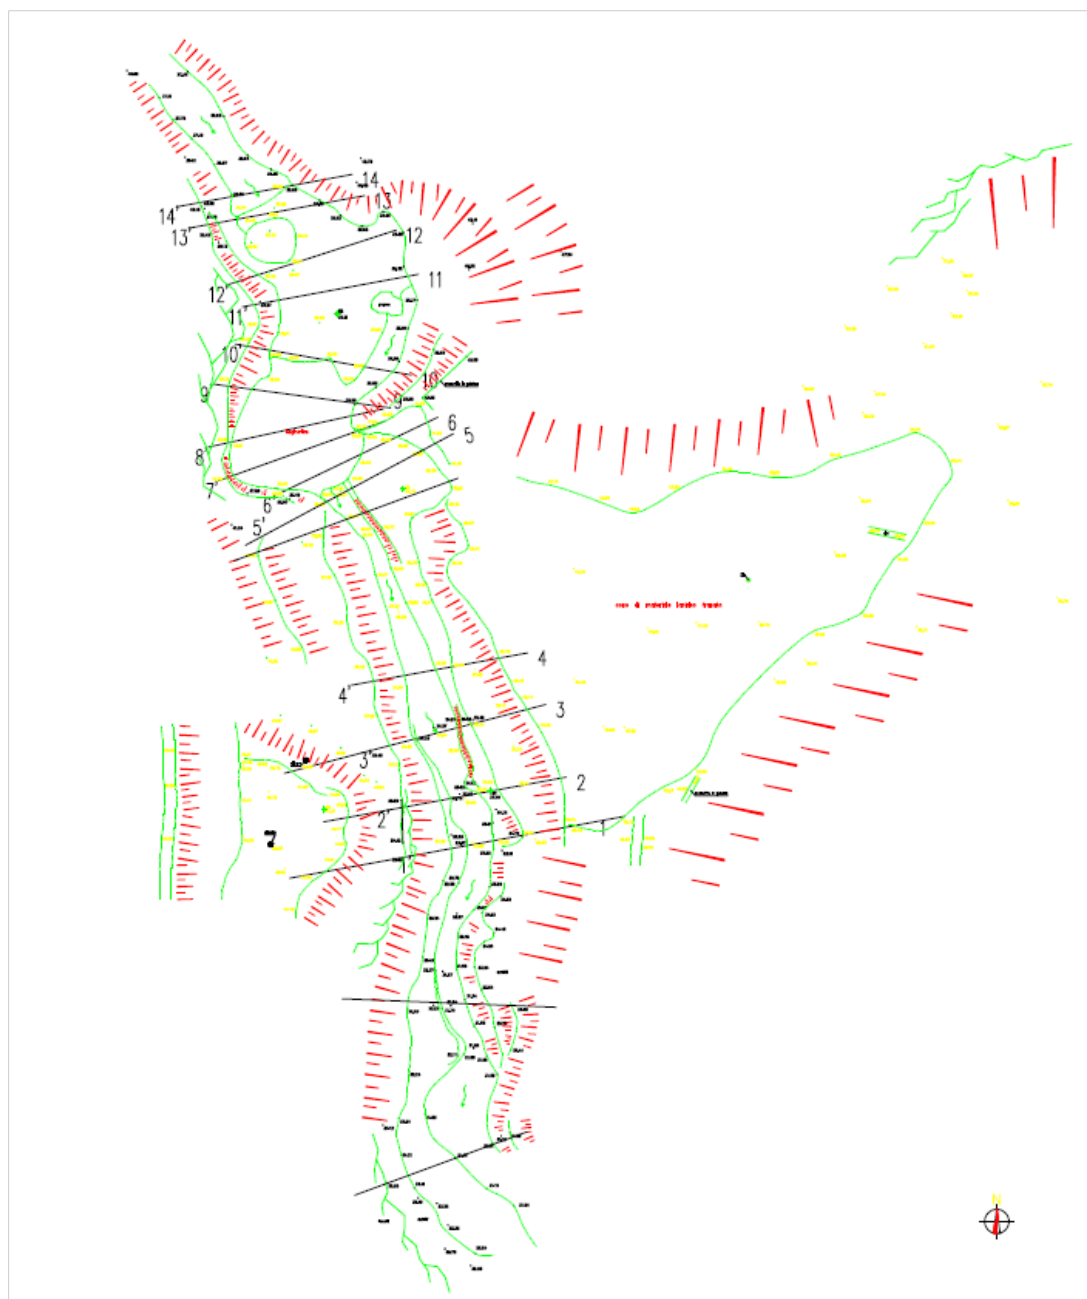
localizzazione sezioni idrauliche. Planimetria di Stato attuale
